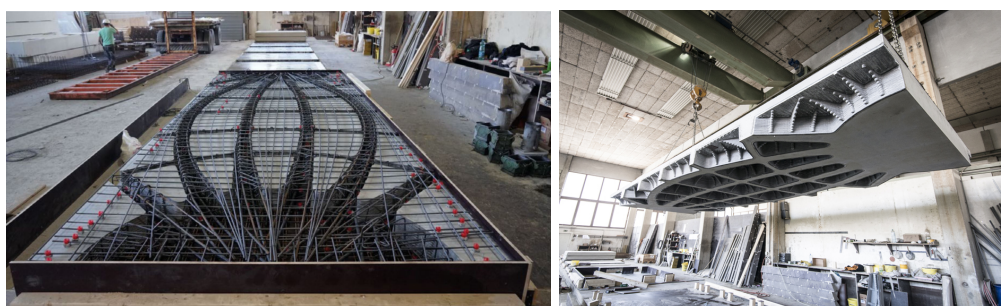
Plancher en béton allégé grâce à l'impression de coffrages permanents en béton. Gauche : Vue de la face supérieure du plancher avant le coulage, mettant en évidence les armatures de renfort, Droite : vue de la sous-face du plancher et des évidements. [37]
